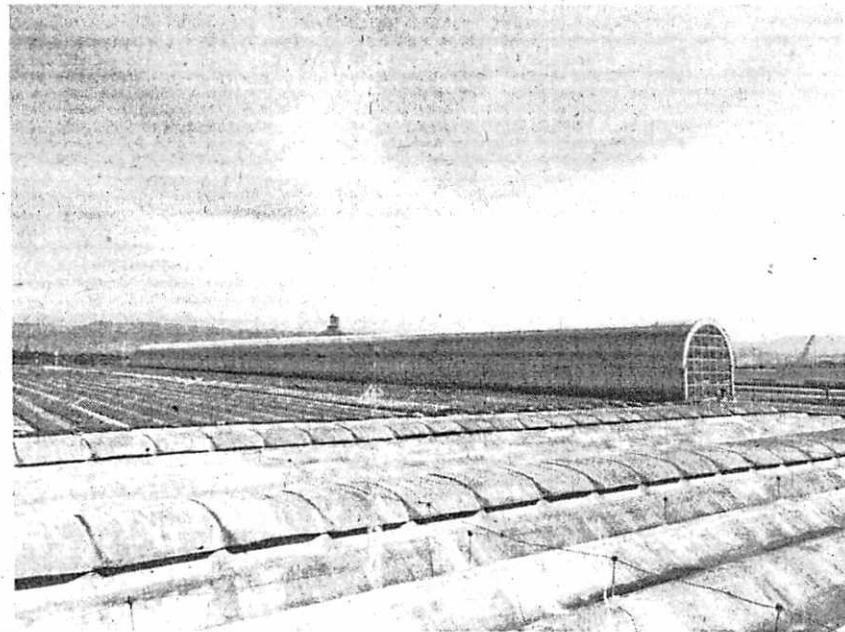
Vista geral do telhado do supermercado que faz parte do conjunto do shopping center.
